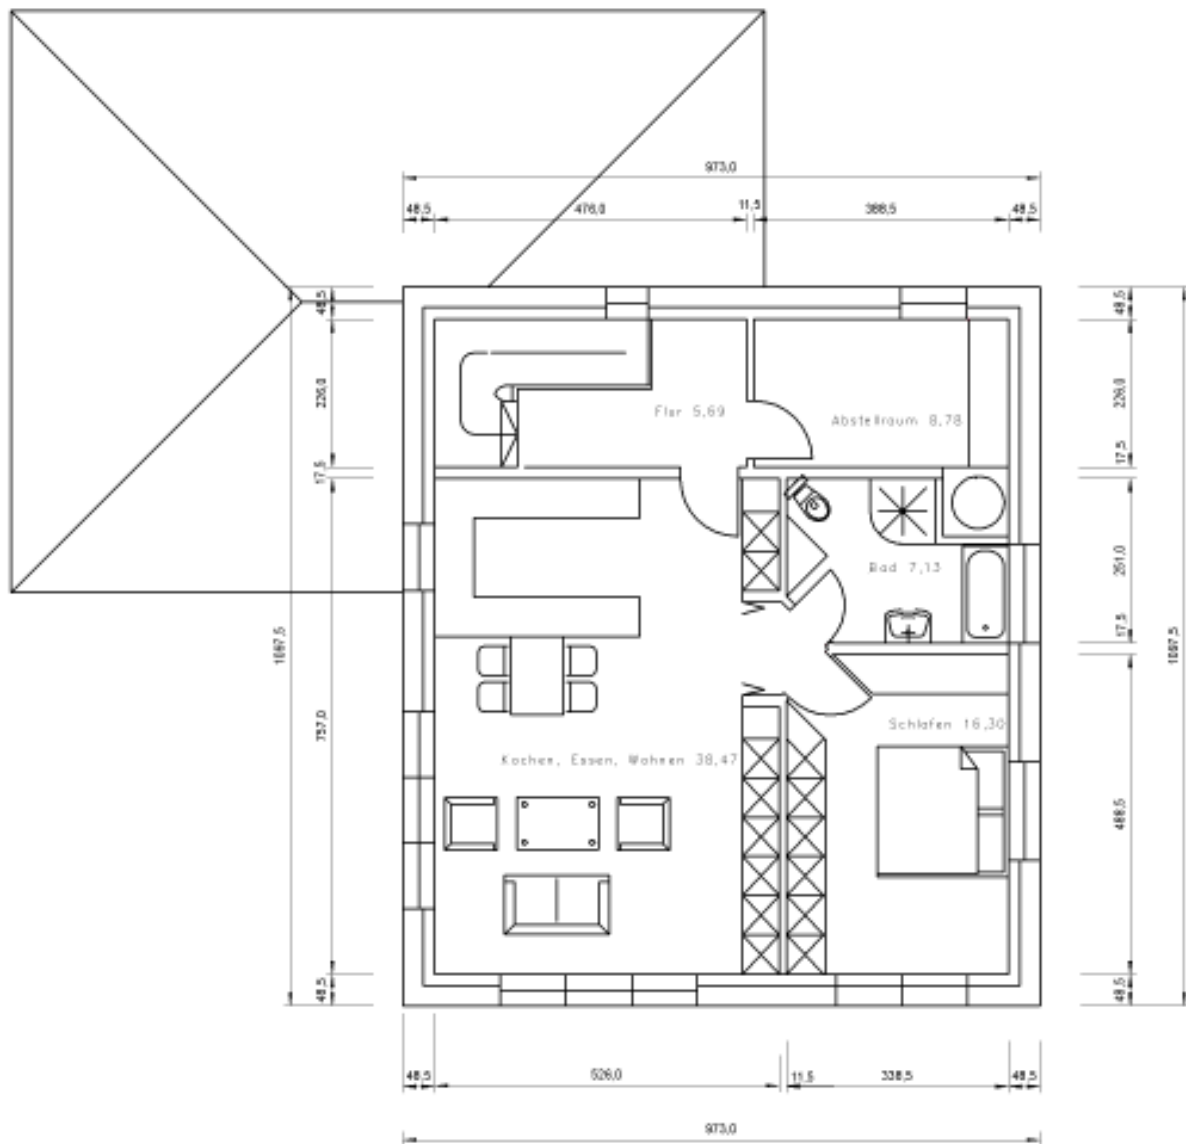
Grundriss OG (Quelle: Architekturbüro Trykowski).
